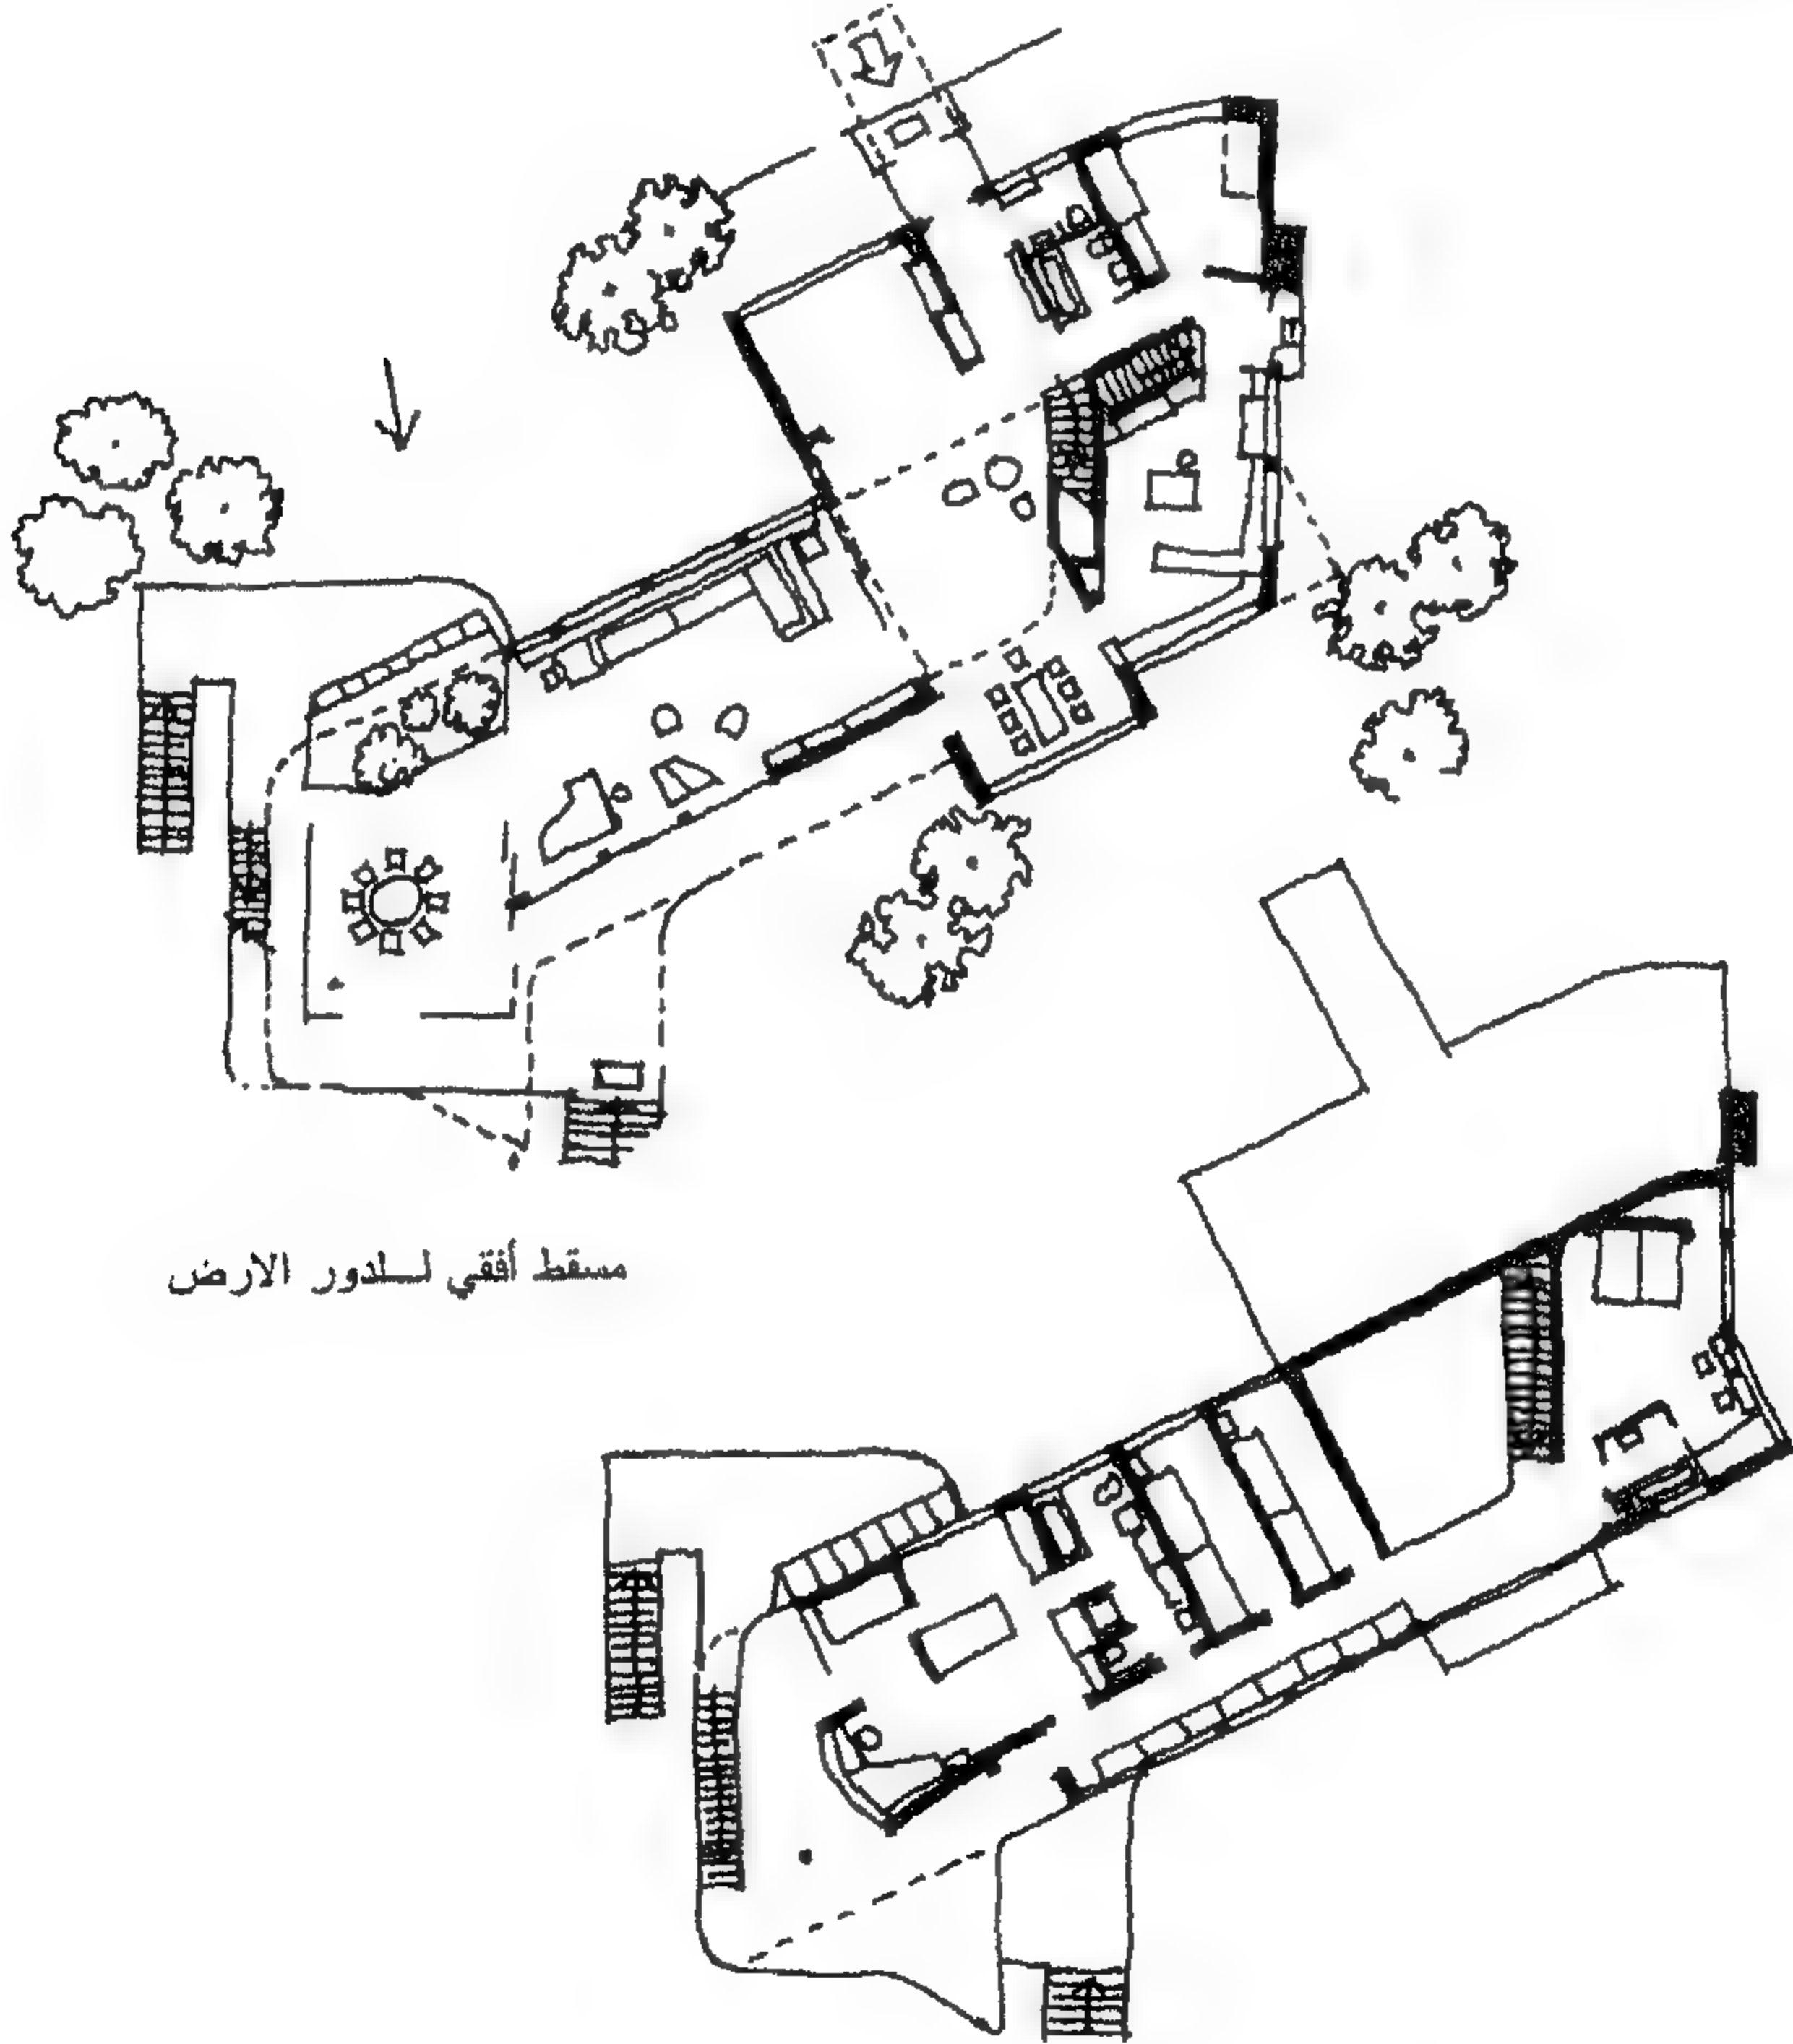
مشروع بيت شباب 1928 - 1929 - مسقط افقى للدور الارضى
